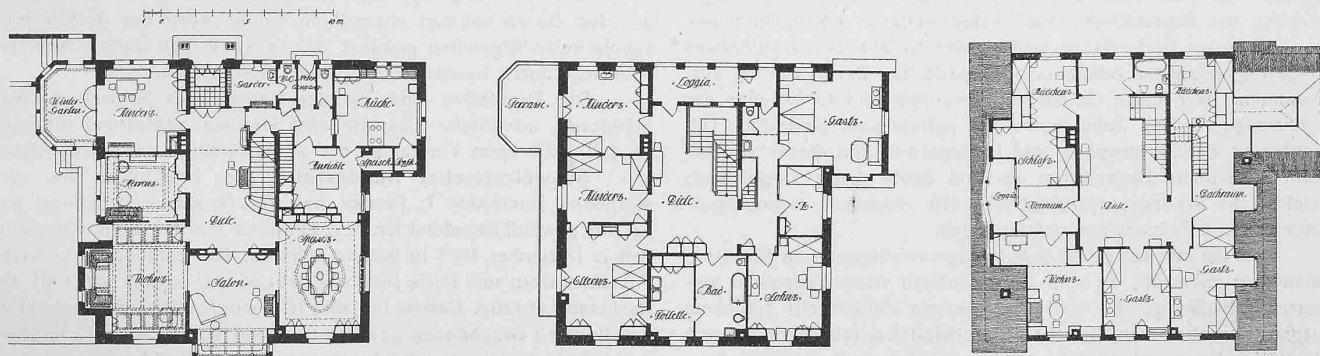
bis 4. Grundrisse vom Erdgeschoss, I. Stock und Dachstock. — Masstab 1:400.
